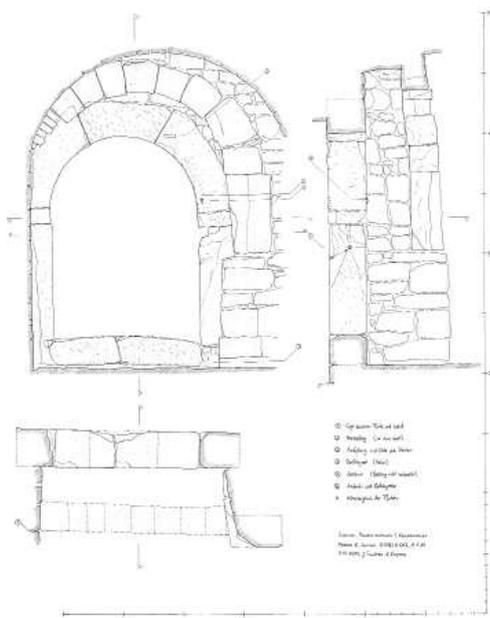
Handzeichnung der vermutlich ältesten erhaltenen Kellerpforte K (zwischen K.018 und K.017) in Ansicht, Schnitt und Grundriss (M 1:10).
